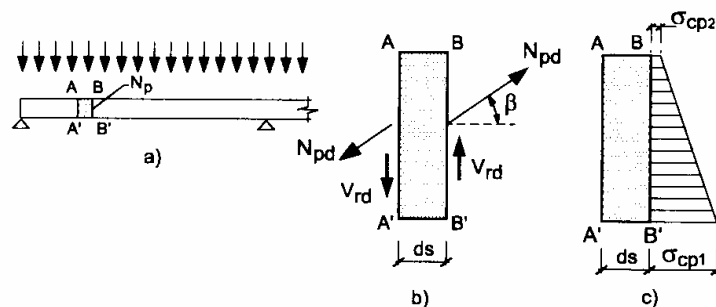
Solicitaciones en un elemento lineal pretensado (Proyecto y Cálculo de Estructuras de Hormigón / Calavera)
